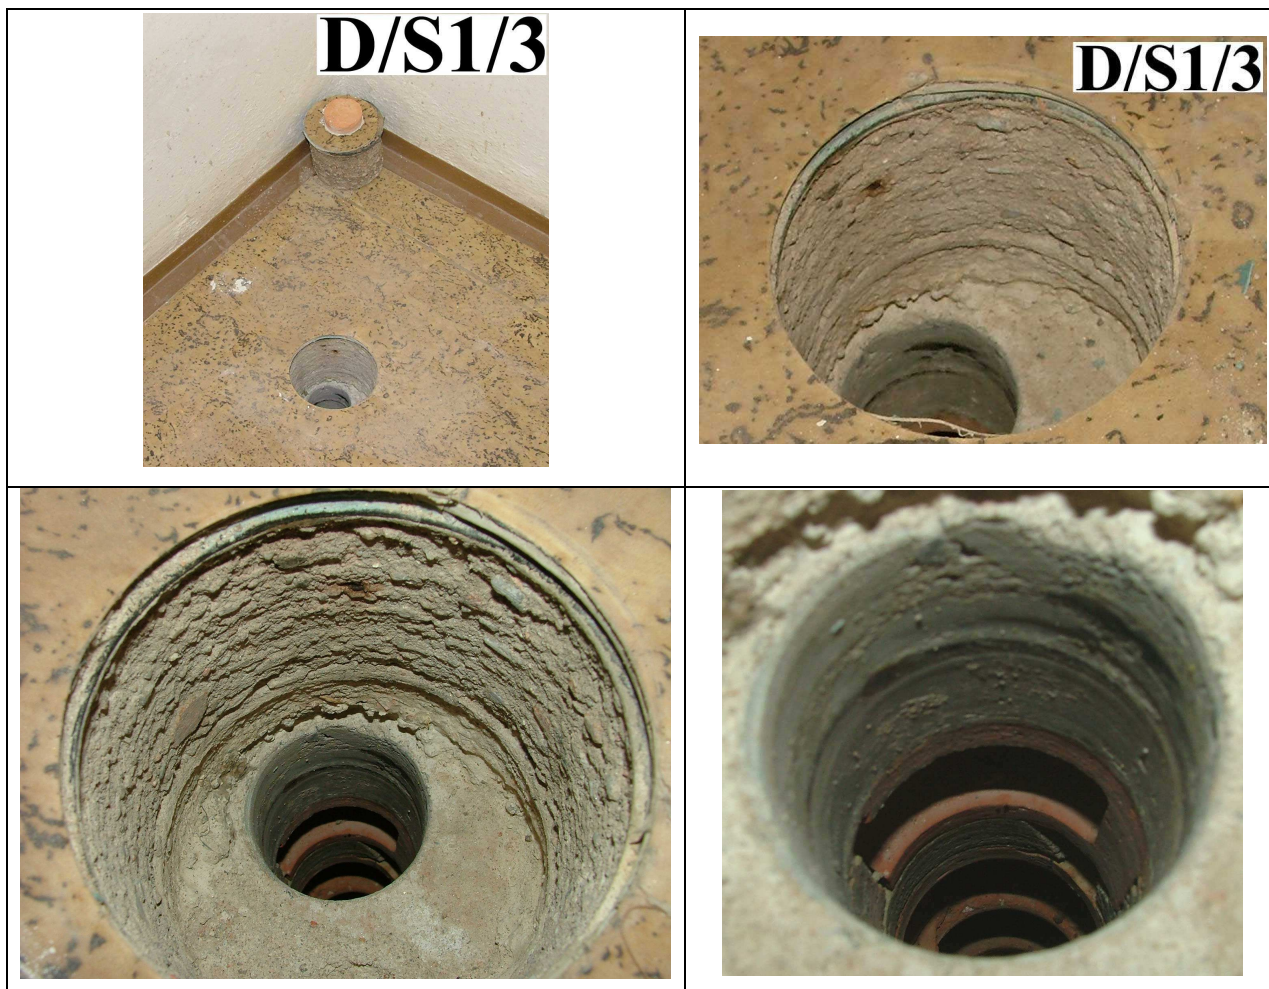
Sonda D/S1/3, podlaha 1. NP (učebna), stropní konstrukce nad skladem v 1. PP
